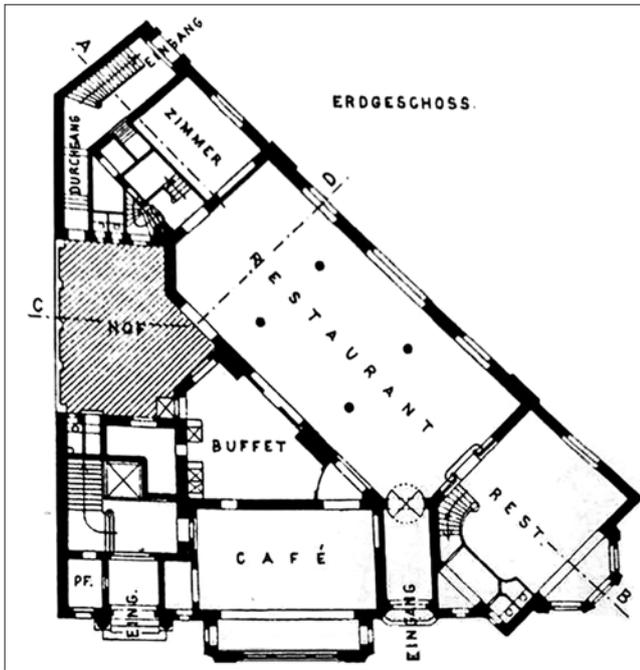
Grundriss Erdgeschoss, 1902
